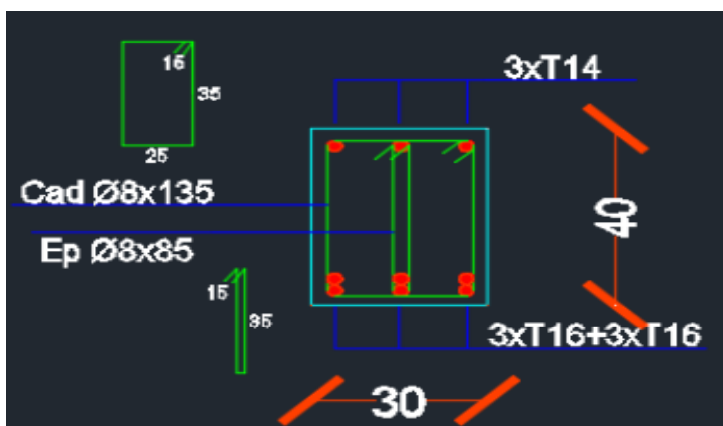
Ferrailage des poutres principales au niveau de travée
